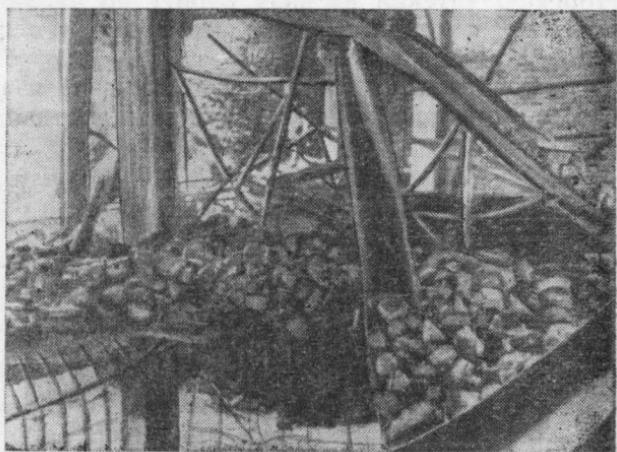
Деформированные металлические балки на пятом этаже холодильника.
